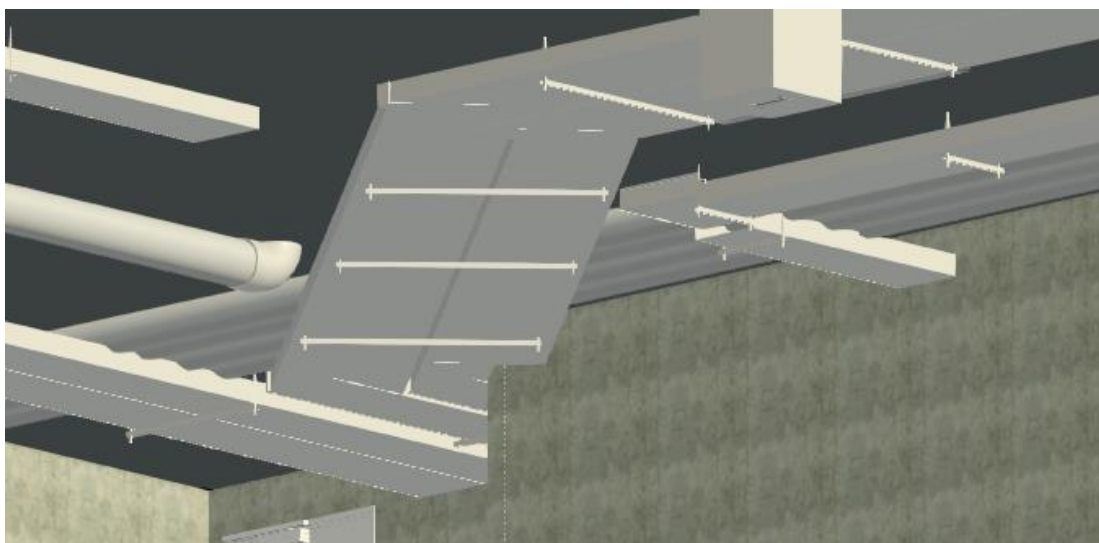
Modelado de los soportes de cables del Garaje Fuente: Elaboración Propia
